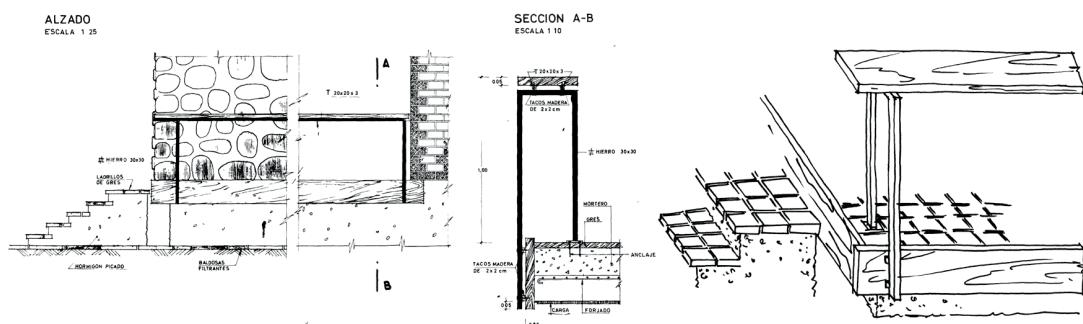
Poblado de Santa María de Garoña (1965-68). Detalle de la barandilla.
